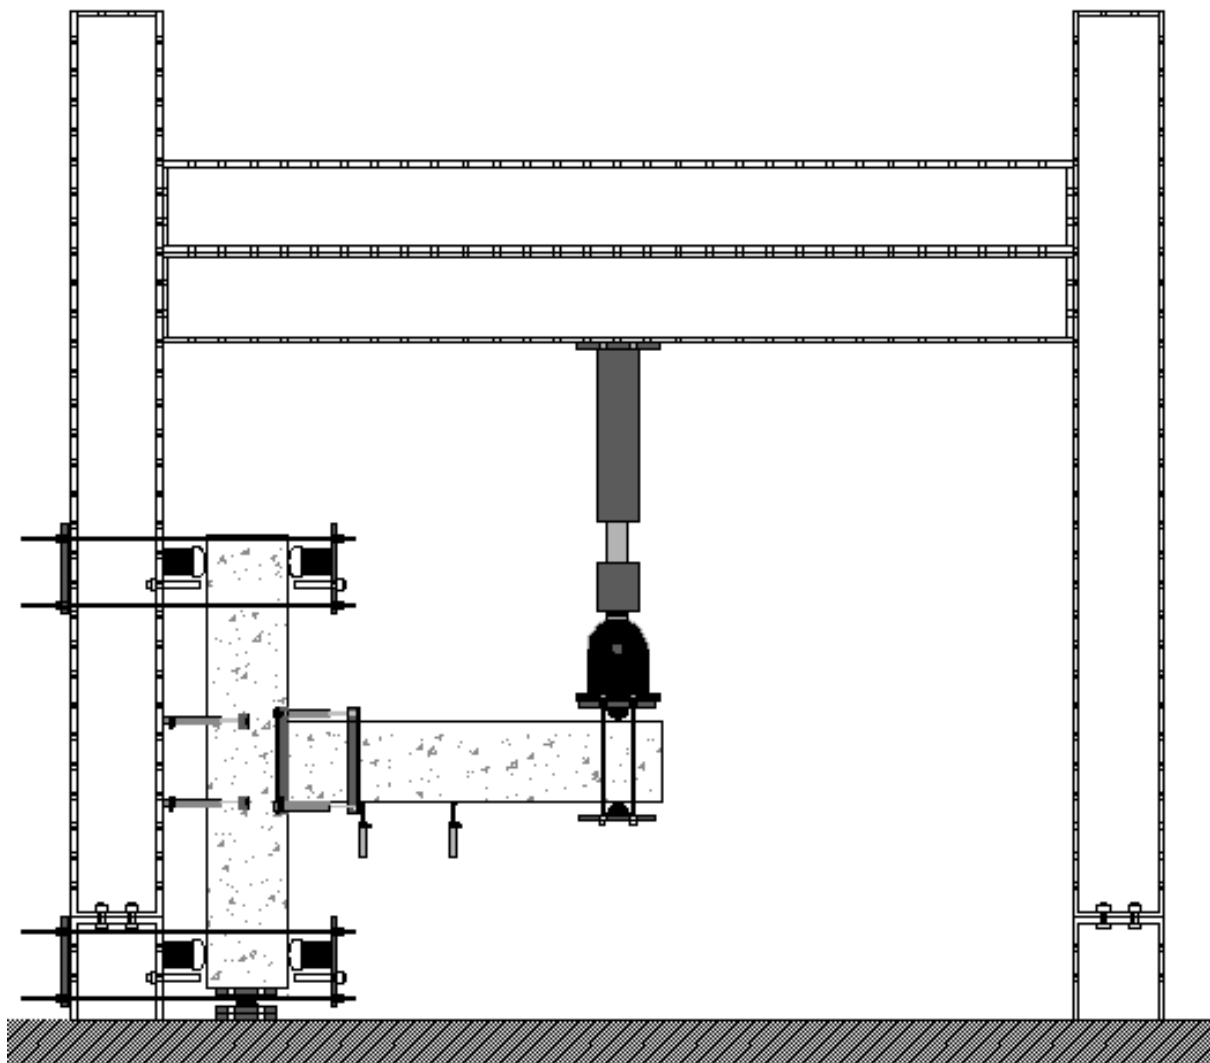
Esquema do pórtico e equipamentos de ensaio
